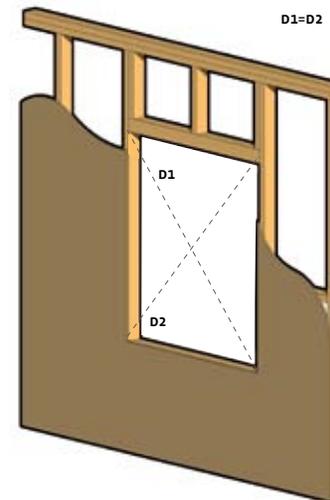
, el mortero cemento permite combinar las ventajas que tienen una construcción en madera con la adaptación arquitectónica a zonas donde hay una predominancia y tradición de construcciones de albañilerías o adobe, con una excelente protección.
